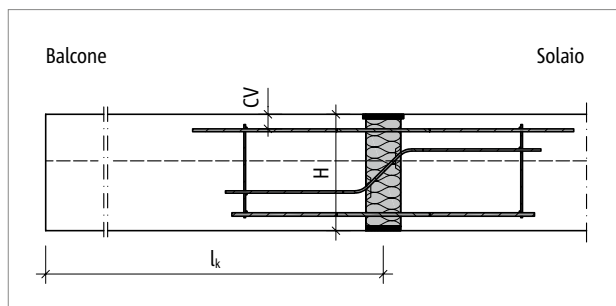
Schöck Isokorb® XT tipo BP: schema statico
